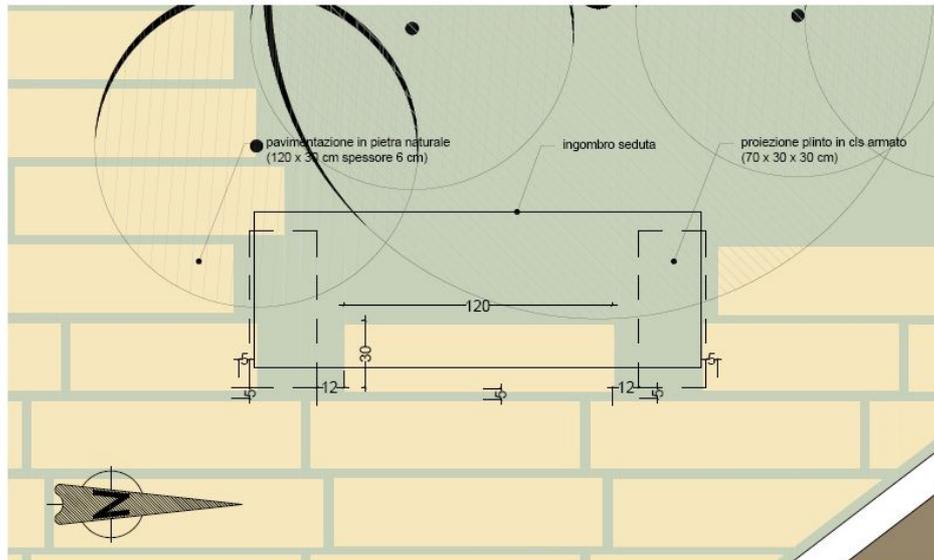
PROGETTO ESECUTIVO - Stralcio della tavola 0241, dettagli posa pietra
